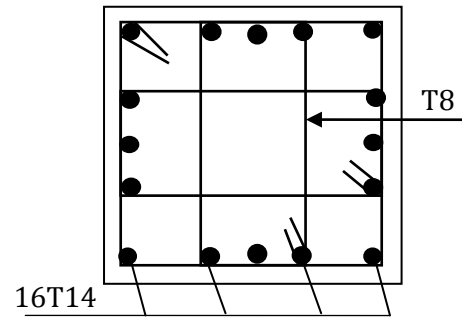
Schéma de ferrailage des poteaux 6<sup>ème</sup>, 7<sup>ème</sup> étage.
